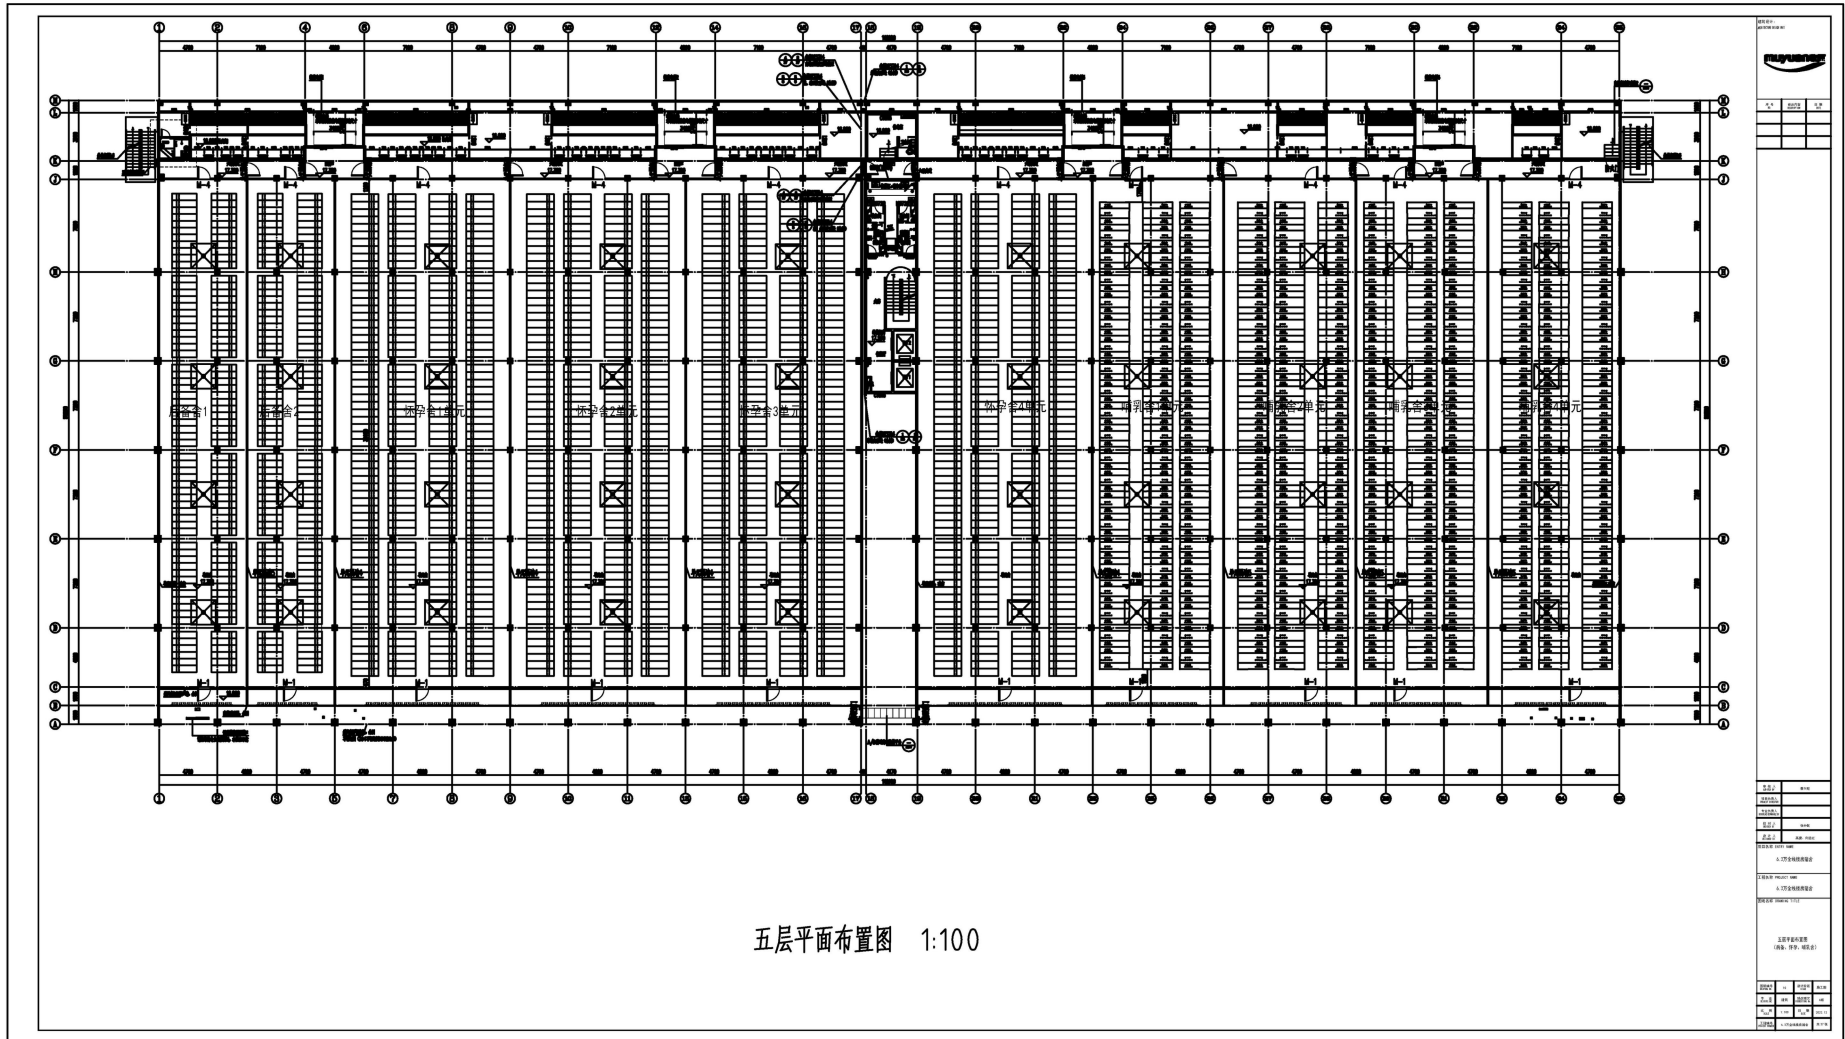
楼房猪舍（5层）平面布置示意图
